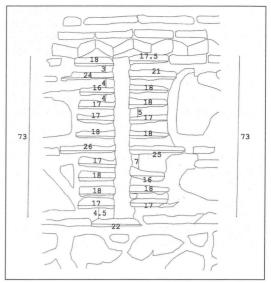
Detalle de saetera en la fachada SE (mihrab)
